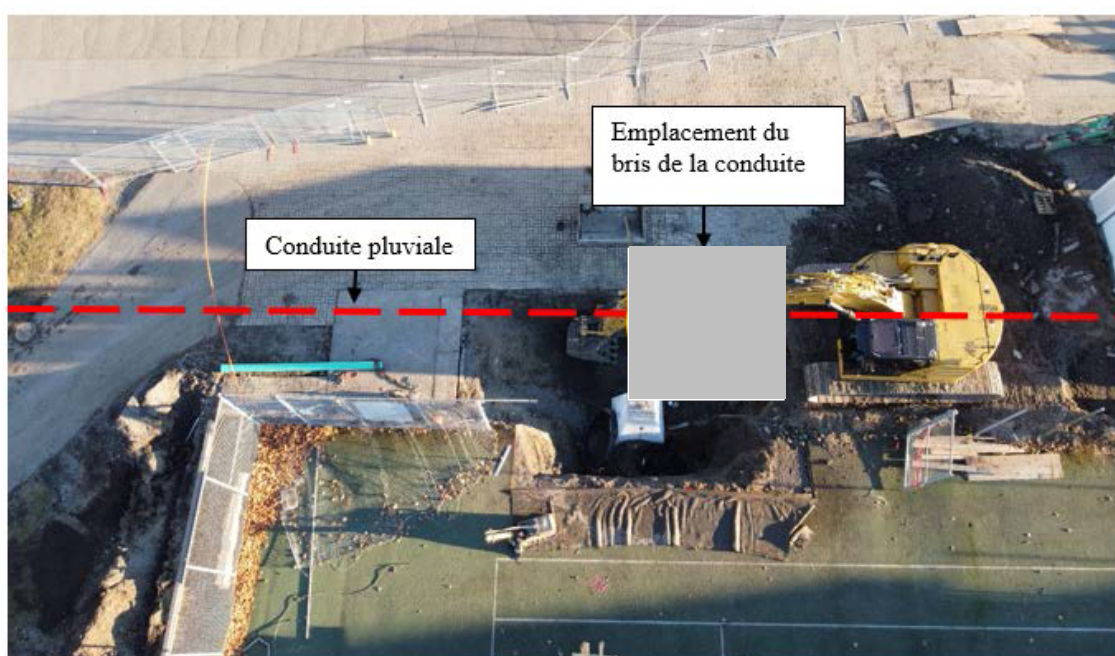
Emplacement du bris de la conduite pluviale
